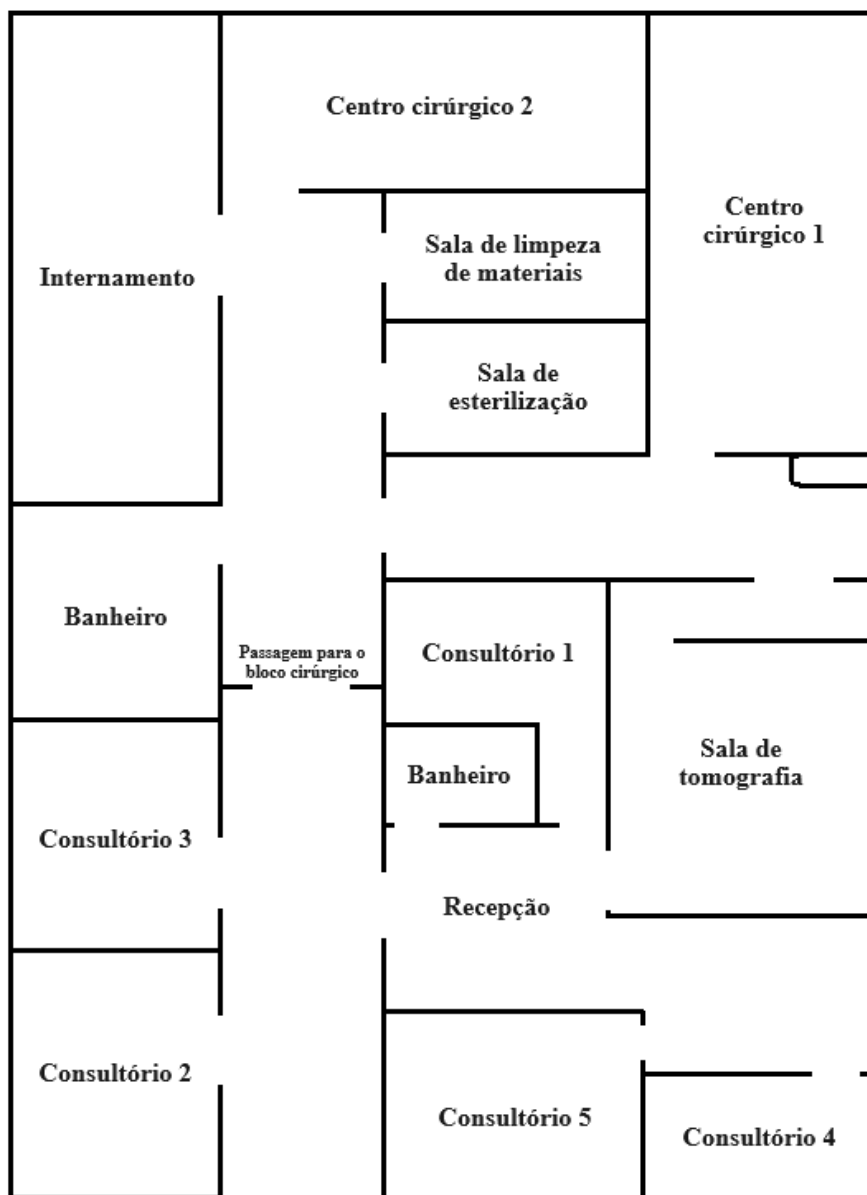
Planta baixa do CIVET. Fonte: Elaborado pelo próprio autor (2024).
